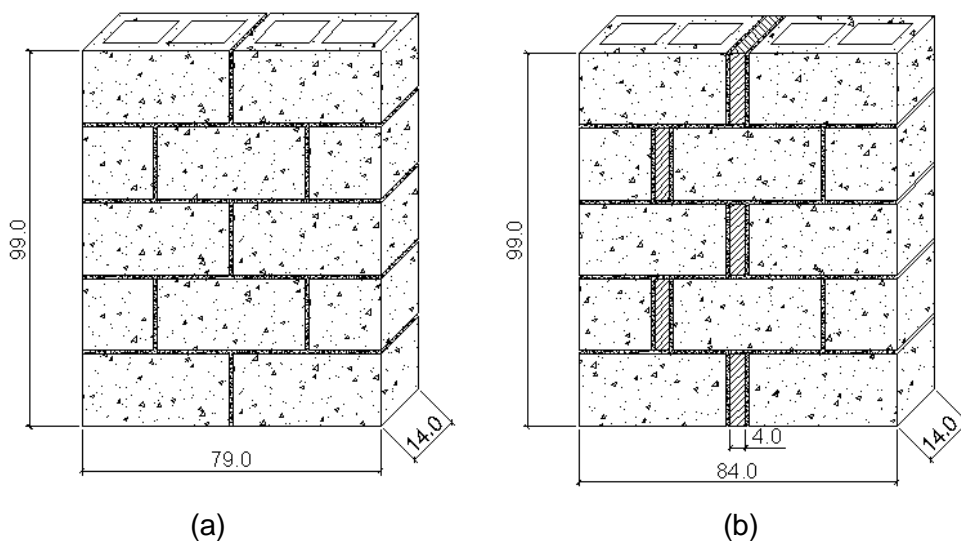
Mini-parede sem rapadura (a); mini-parede com rapadura (b) (medidas em cm).
